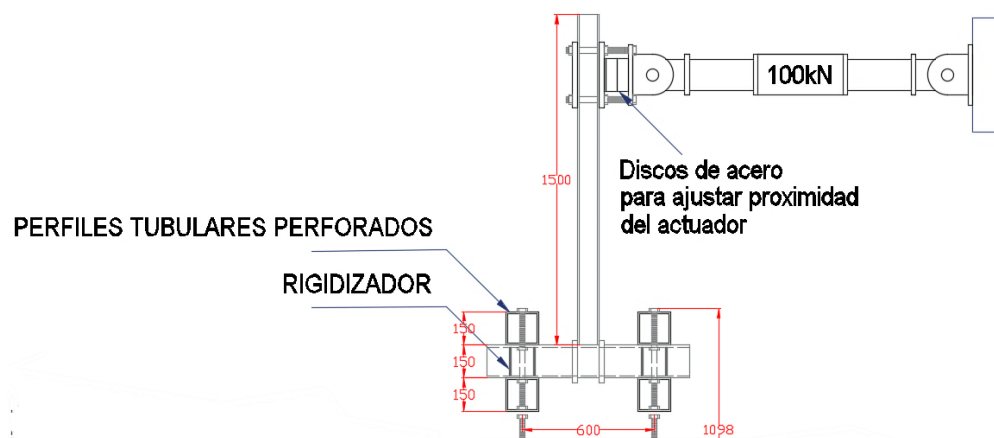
Imagen de aplicador de carga en viga perfil HEA100. Construcción propia
